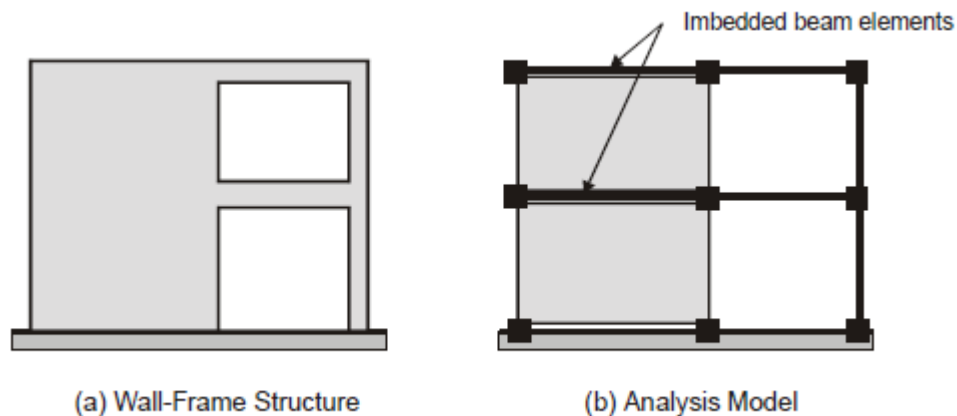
Conexión entre viga y muro. Perform 3D Components and Elements, 2006 [5].
